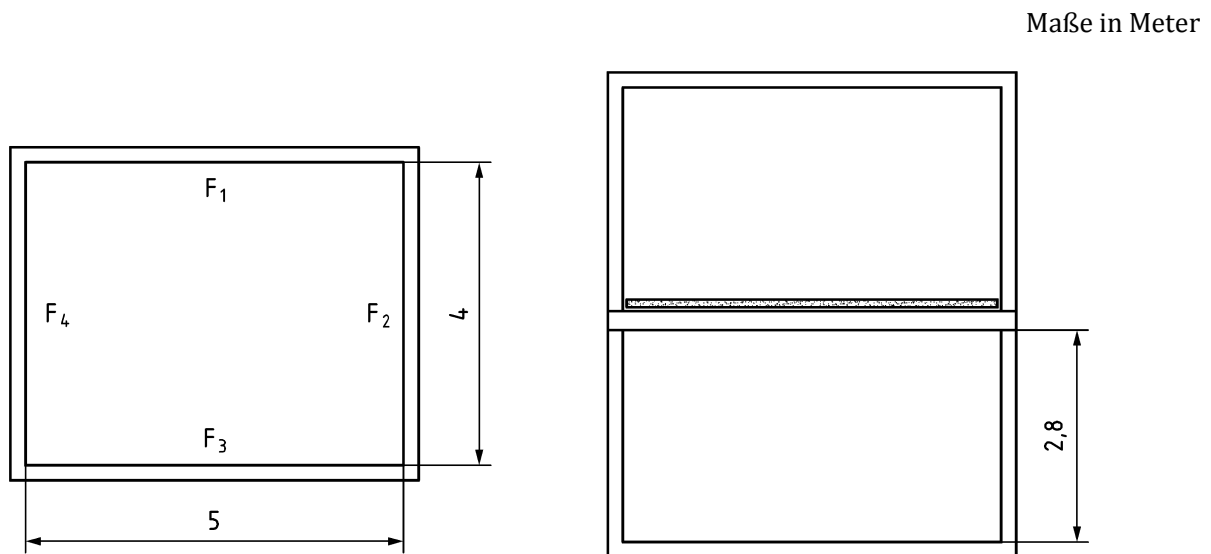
Grundriss (links) und Schnitt (rechts) zweier übereinanderliegender Räume im Holzbau (Prinzipskizze)
